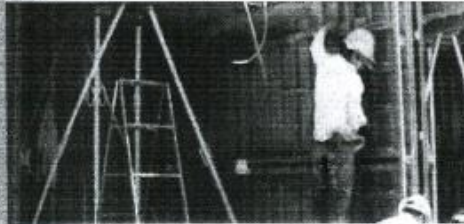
"Colocación de cimbra metálica outinord para losa y muros"
